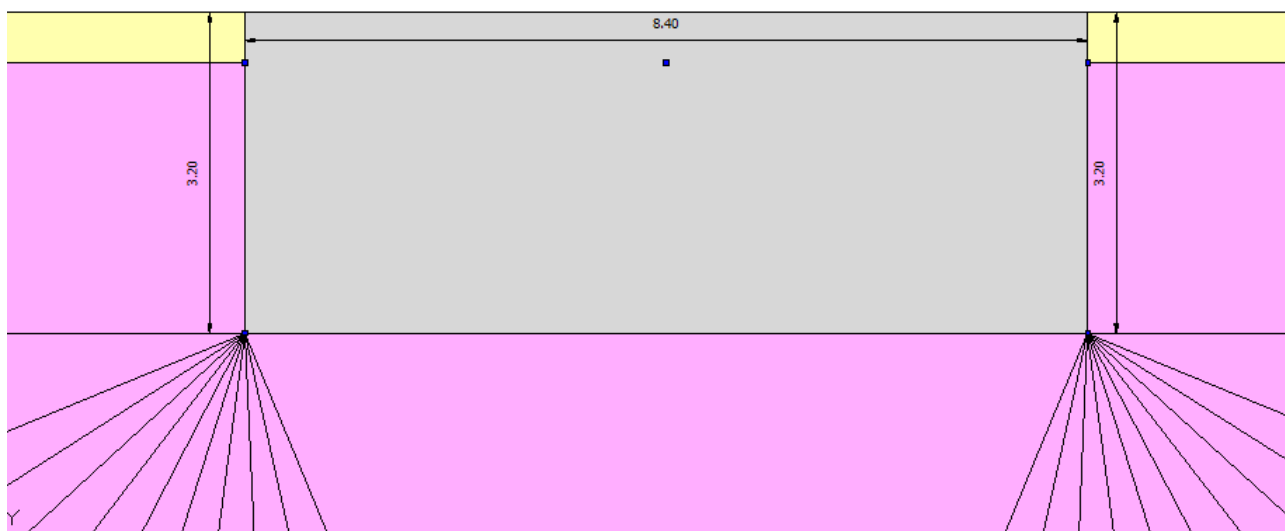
Sezione fondazioni – stratigrafia (dettaglio)
